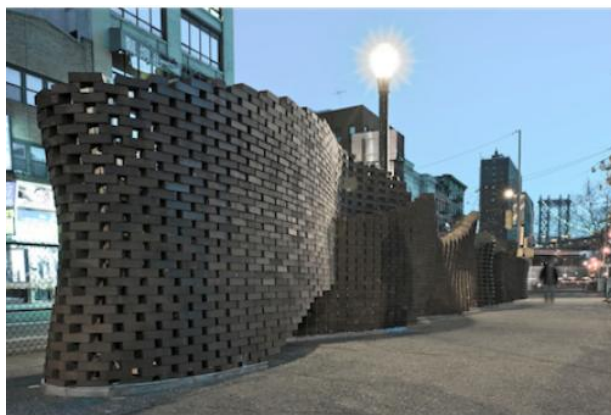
Uso da robótica na construção de uma estrutura de alvenaria, Manhattan.
